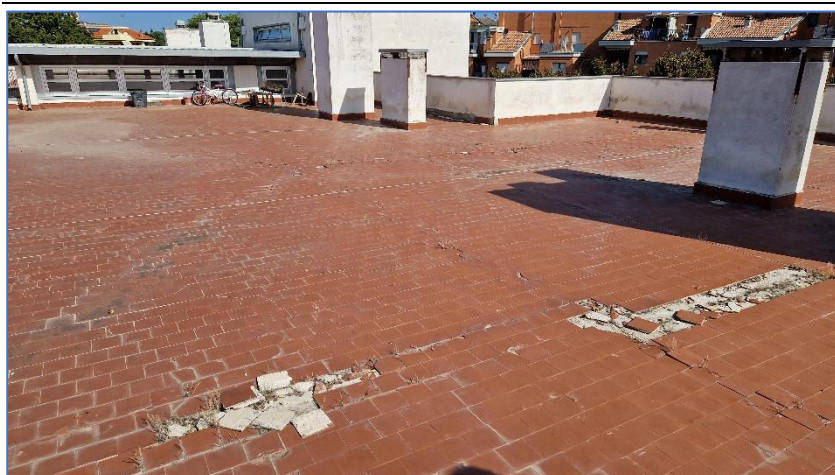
Pavimentazione nella parte sud della terrazza.
